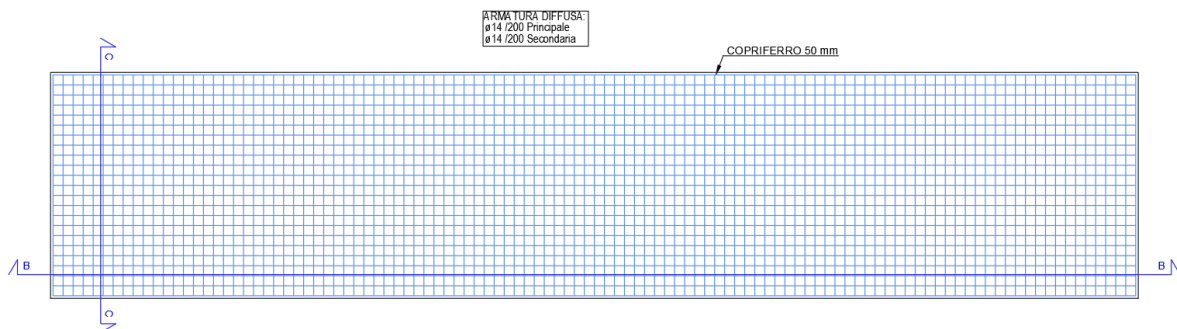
Pianta della platea di Fondazione della Cabina di Centrale
